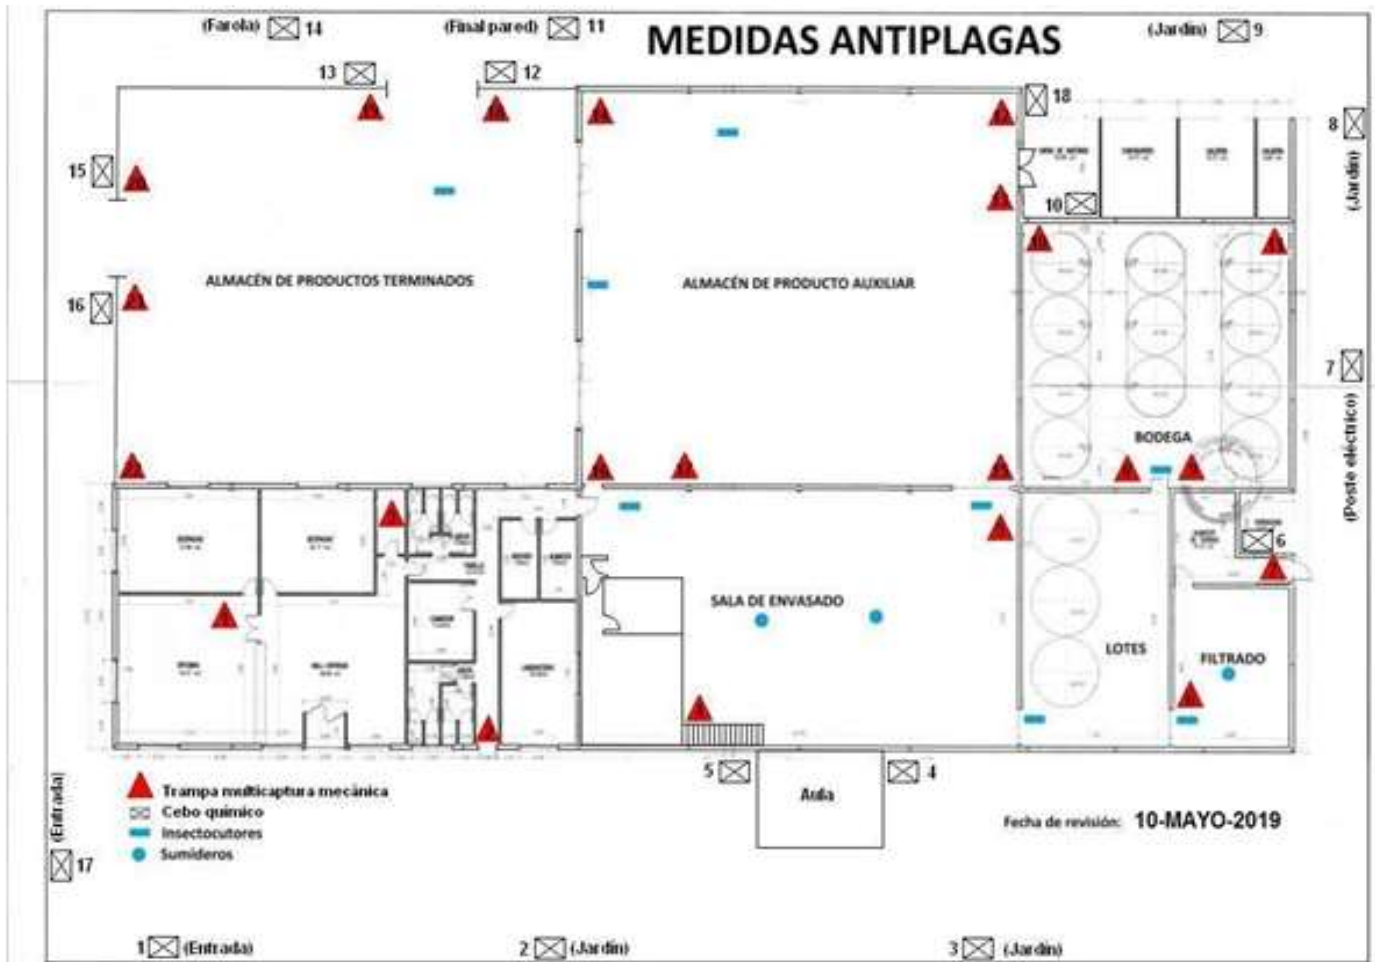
Plano de localización de las medidas antiplagas en la planta envasadora Oleocampo
